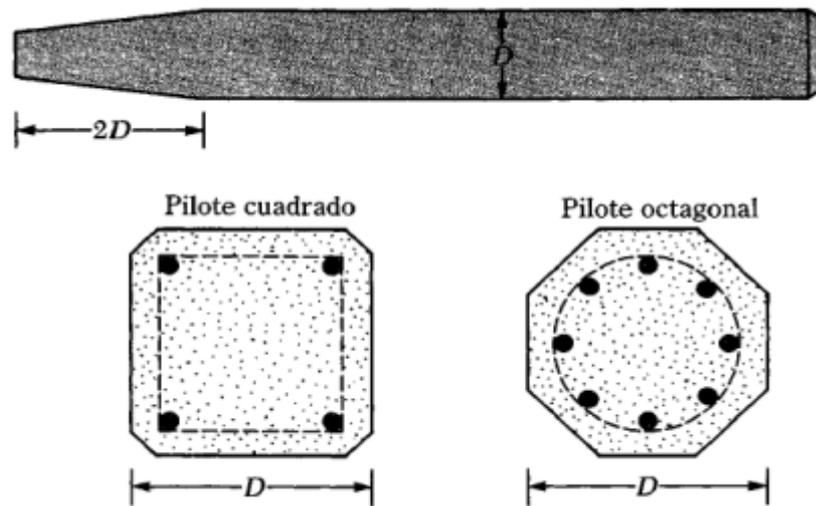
Pilotes prefabricados con refuerzo ordinario. Fuente: Fundamentos Ingeniería Geotécnica, Braja M. Das. (2001)
